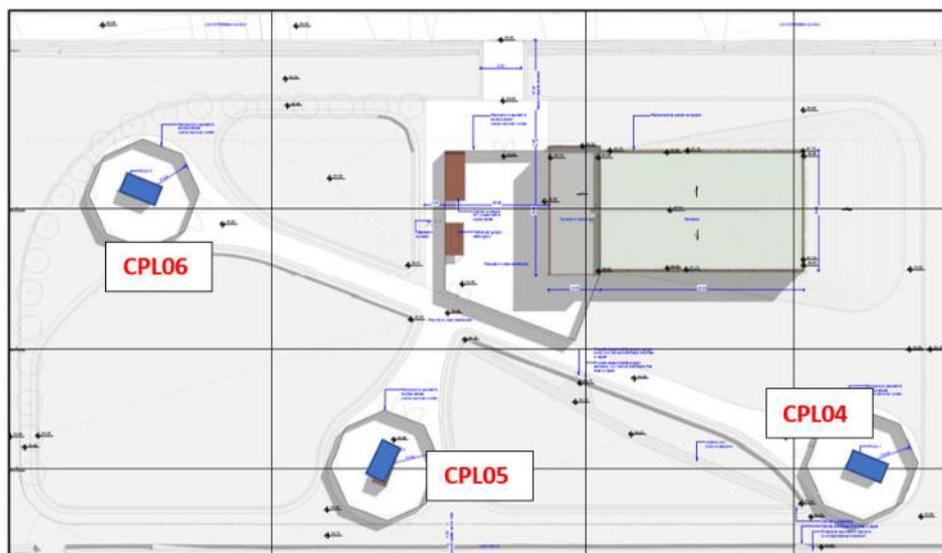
Planimetria centrale con in blu i pozzi in progetto.
